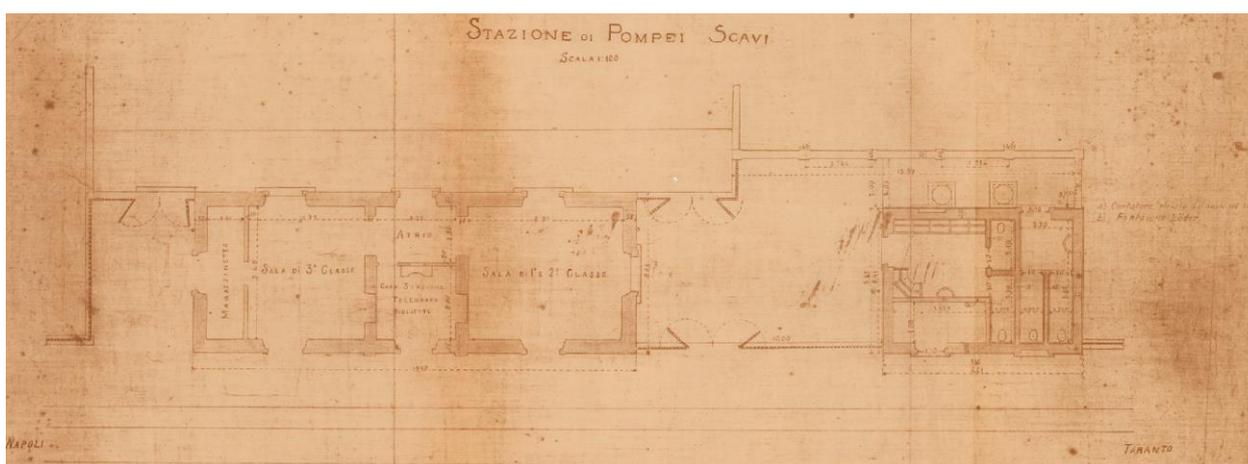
planimetria dei fabbricati della Ex fermata di Pompei scavi - fonte archivio storico FS
